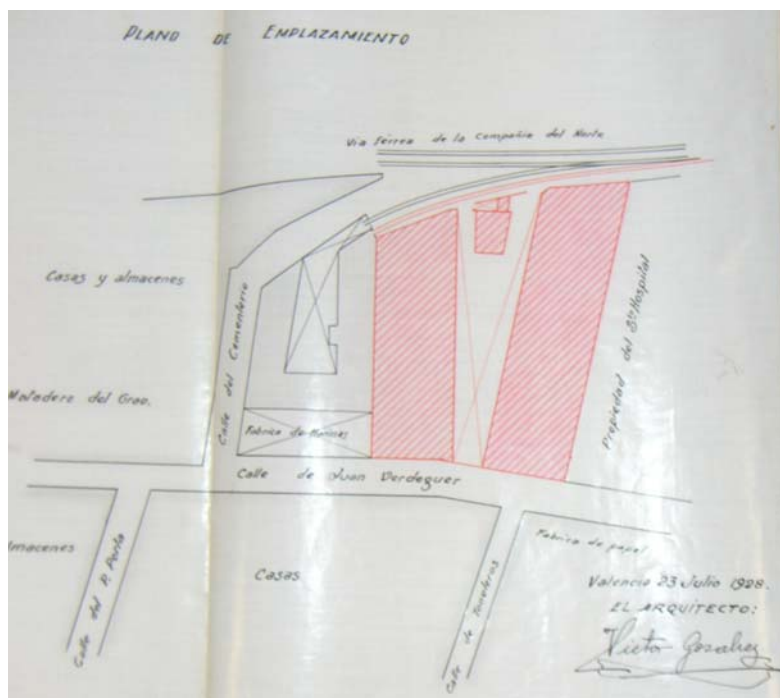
Plano del emplazamiento original de naves de Azamon S.A.<sup>377</sup>
